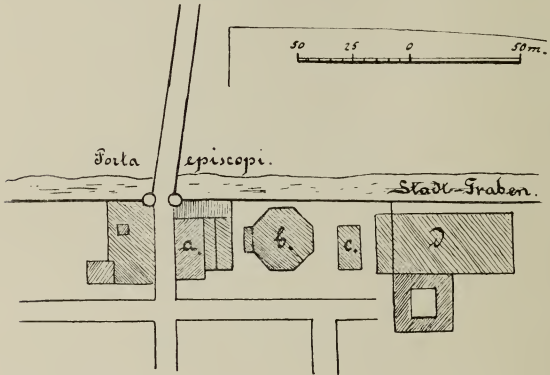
Lageplan des Baptisteriums im Mittelalter.
